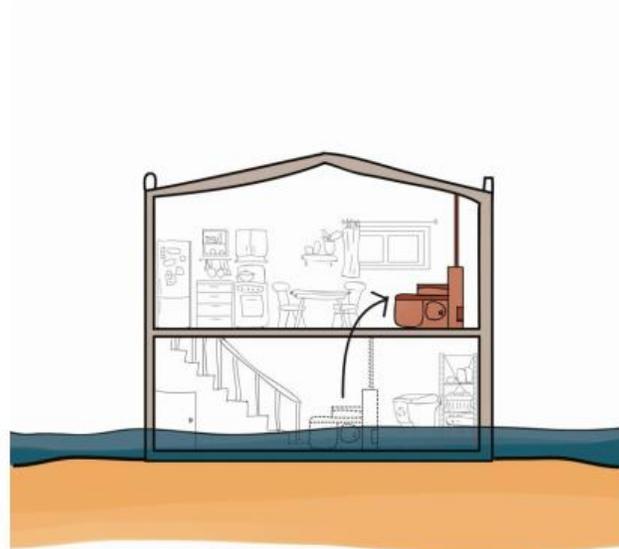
Reubicación de equipos en armario de instalaciones de planta superior (buildingscience.com)
